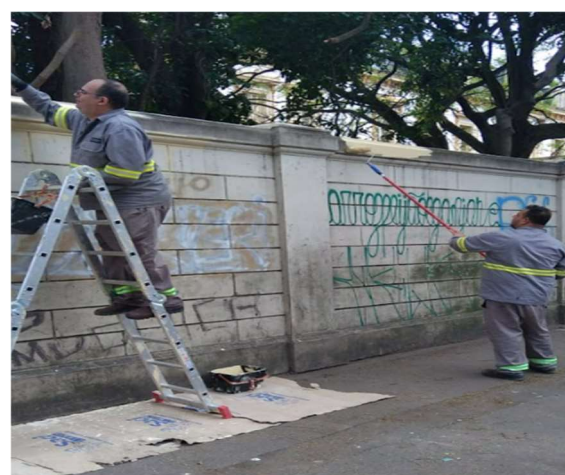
Conservação muros perimetrais, lateral Alameda Gleite.
